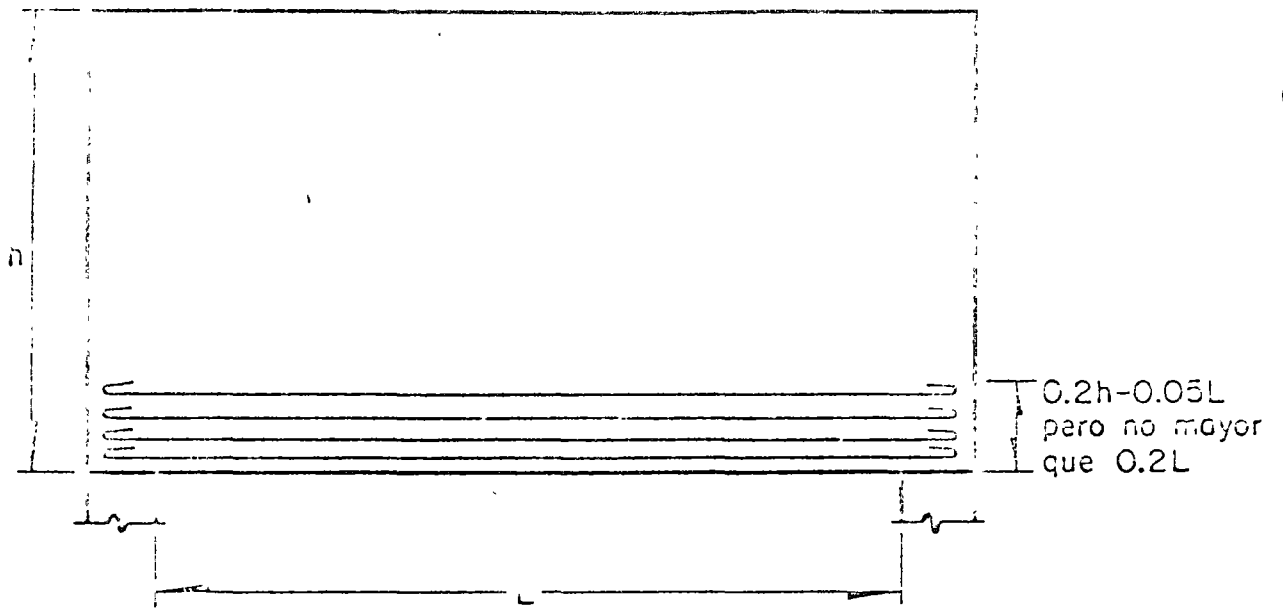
Disposición del refuerzo de flexión en una viga diafragma de un claro
